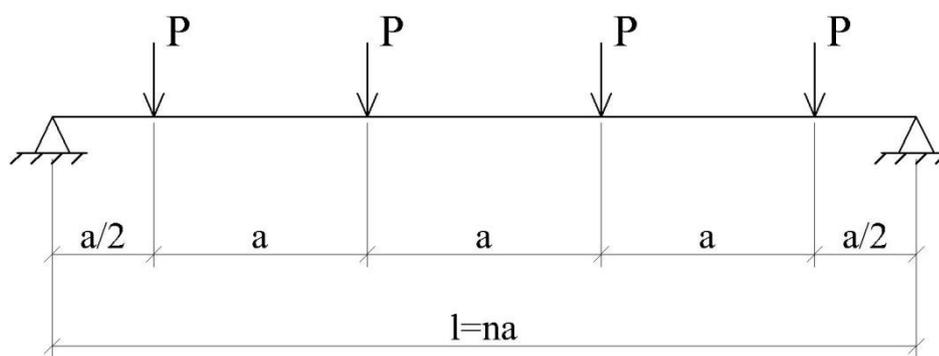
Нагрузка от ребристых панелей перекрытия на ригель
